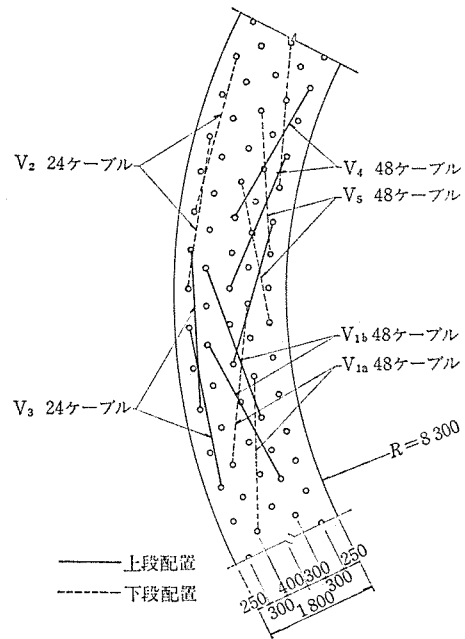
鉛直鋼材配置図 (12 T 15.2 mmケーブル)
